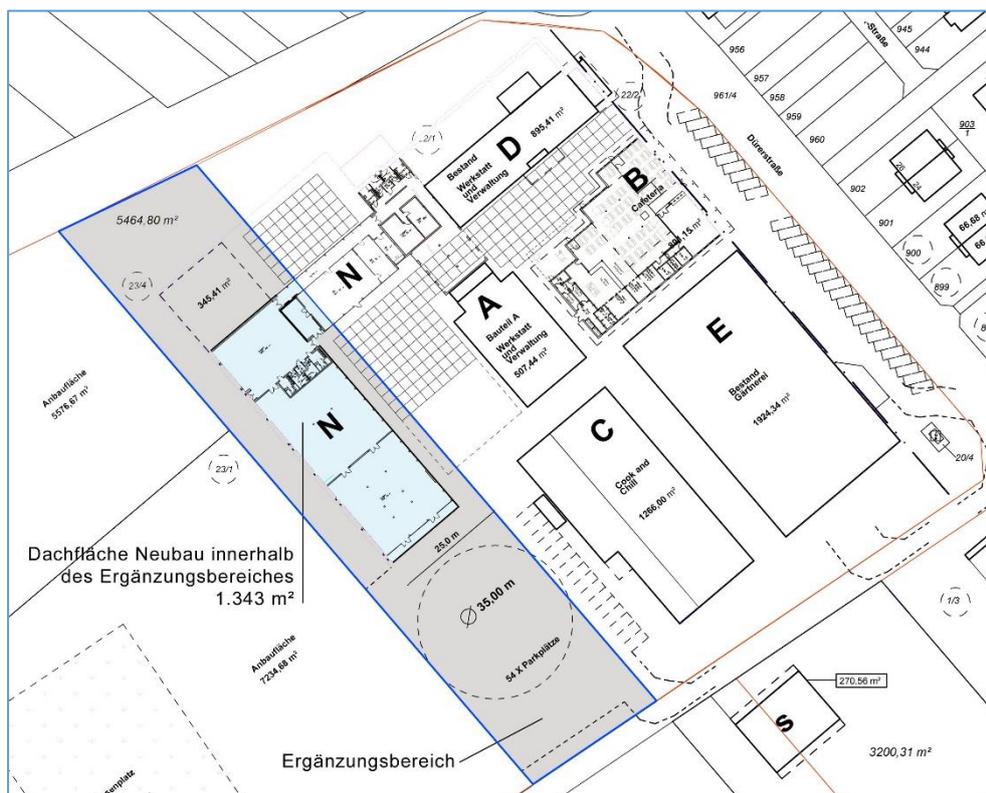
Dachflächen geplanter Neubau innerhalb des Ergänzungsbereichs (ohne Maßstab)
